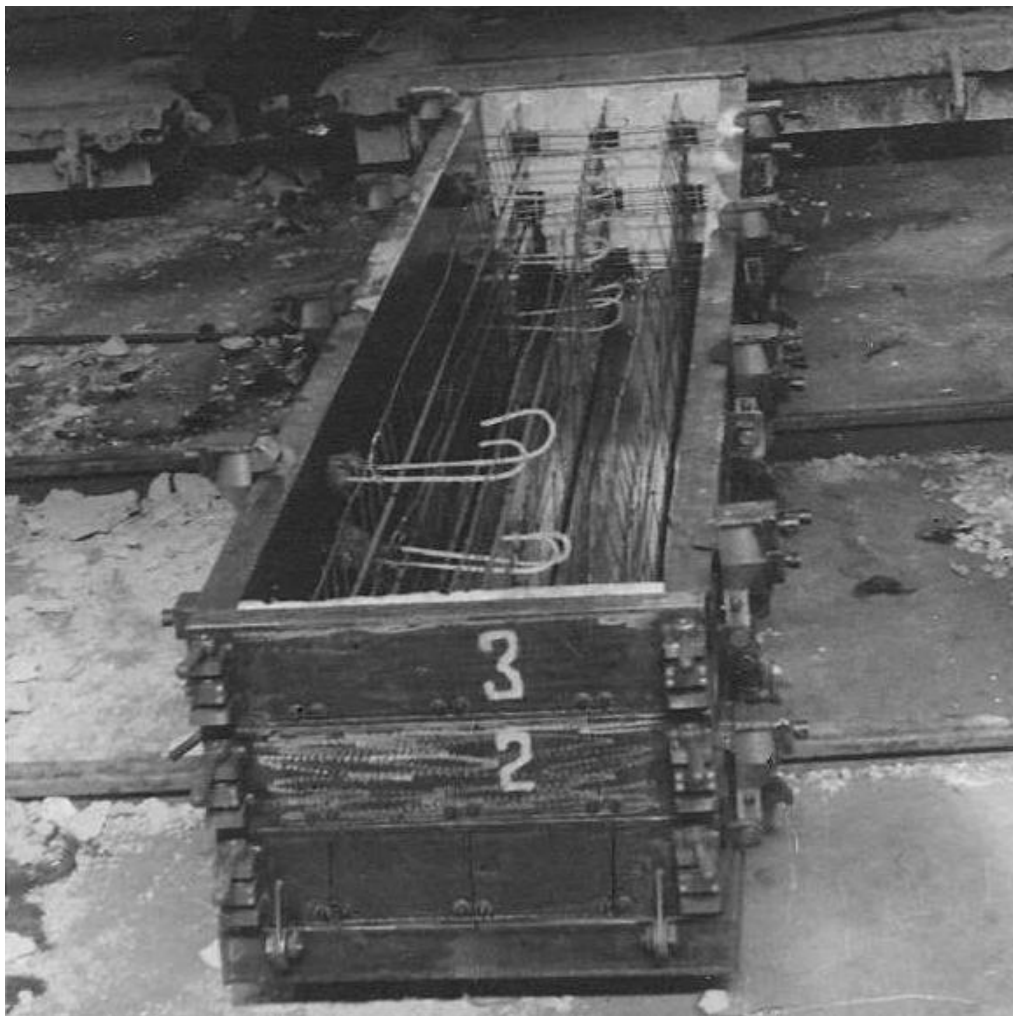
Общий вид опытной формы с установленными преднапряженными плоскими арматурными каркасами перед заливкой газобетонной смеси
